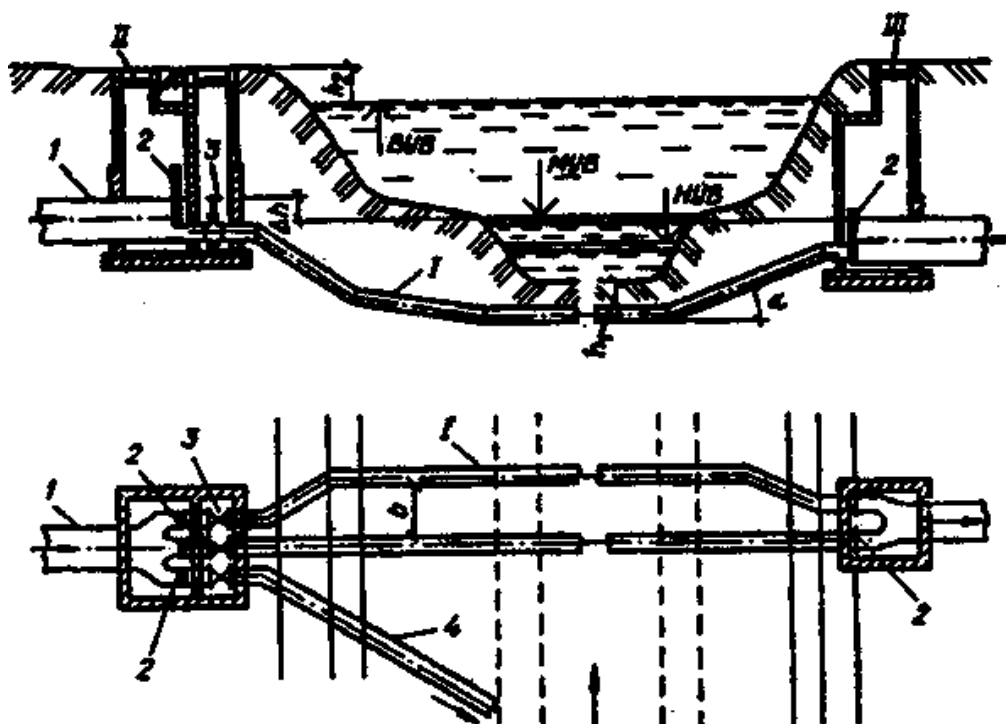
Схема дюкера через реку: I - напорные трубопроводы; II - верхняя камера; III - нижняя камера; 1 - подводный самотечный трубопровод; 2 - щитовые затворы; 3 - задвижки; 4 - аварийный выпуск
